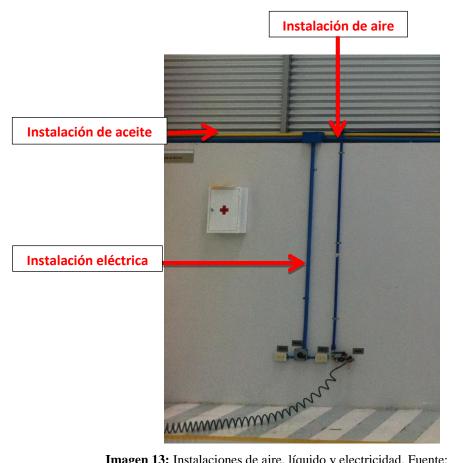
Instalaciones de aire, líquido y electricidad. Fuente: Autores.
